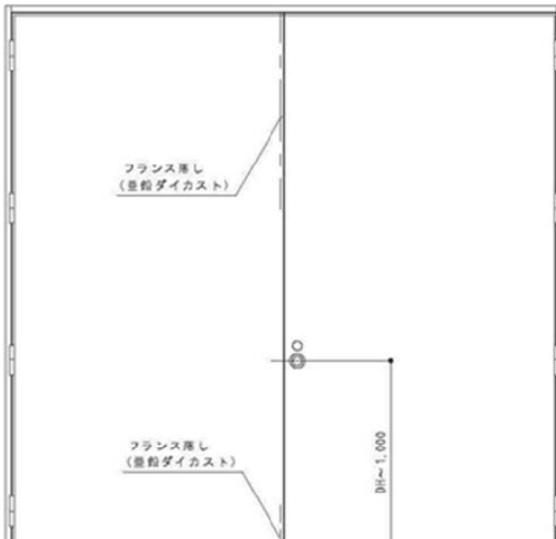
(1)-2 変更範囲に関する概要図 (平面図)
